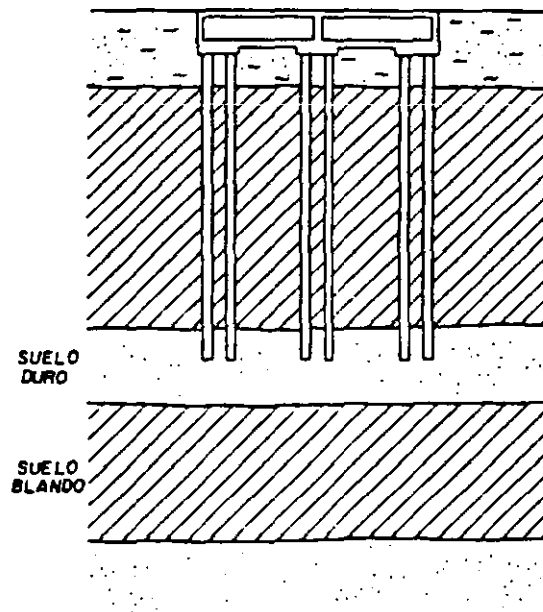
Cimentaciones profundas con pilas o pilotes de punta
